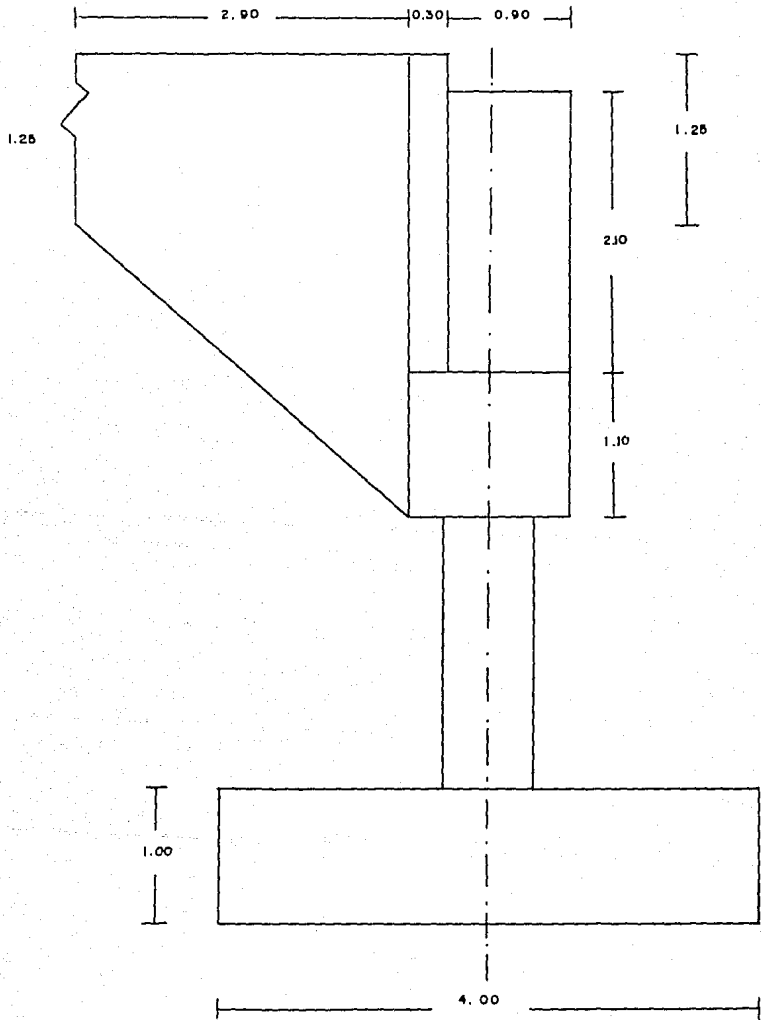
CORTE NORMAL AL EJE DE APOYO
